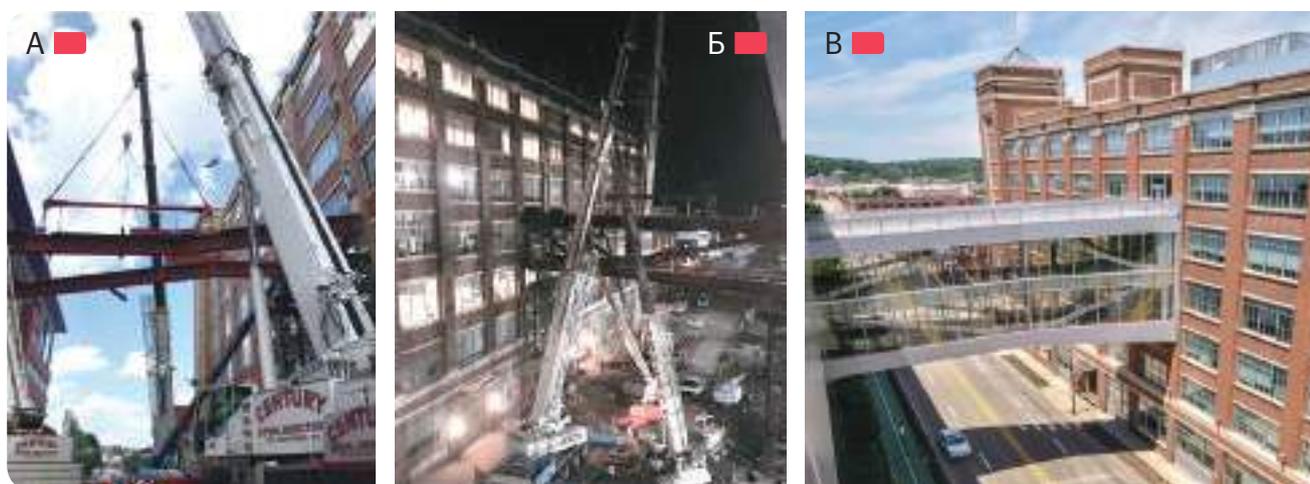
Трехуровневый стальной мостовой переход между существующими зданиями Bakery Square и Google Office весом 170 тонн был закончен всего за 6 недель в г. Питтсбург, США 2016 г.: А – монтаж нижних поясов ферм; Б – ночные работы по монтажу верхних поясов и раскосов, В – завершённый переход
